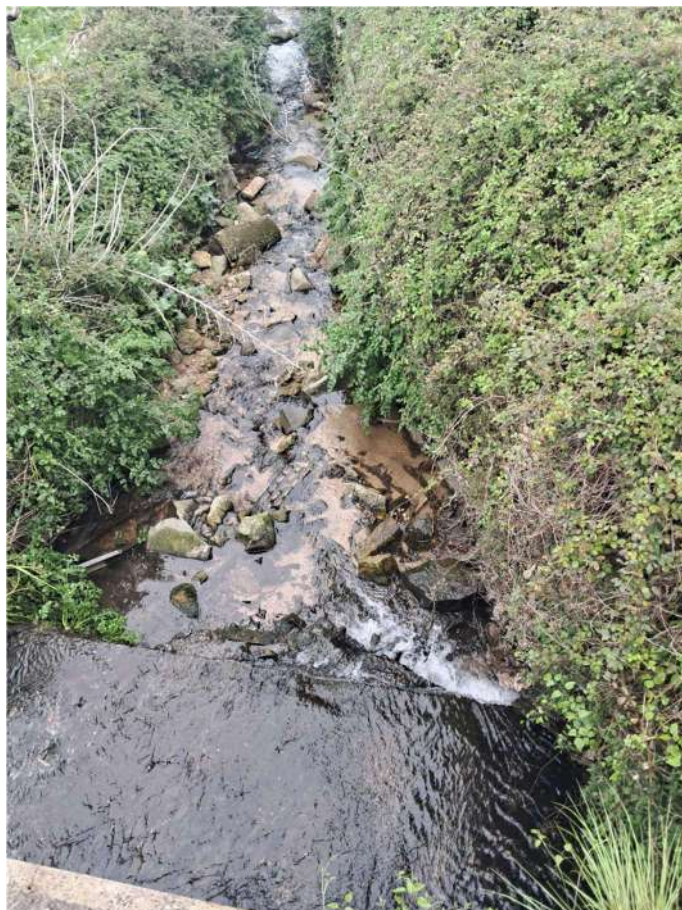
Loc. Santa Margherita - Riu Barrottu uscita sottopasso s.s 127
